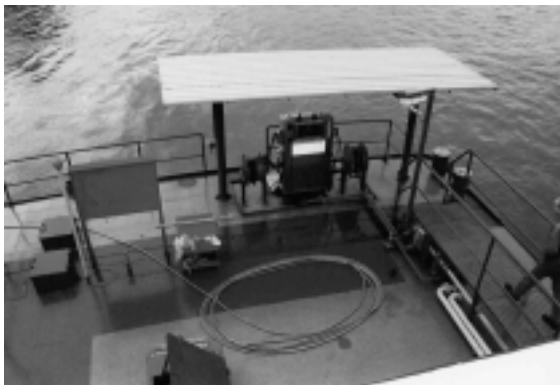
Vývazovací pontón pre malé plavidlá (cca do 12 m)
